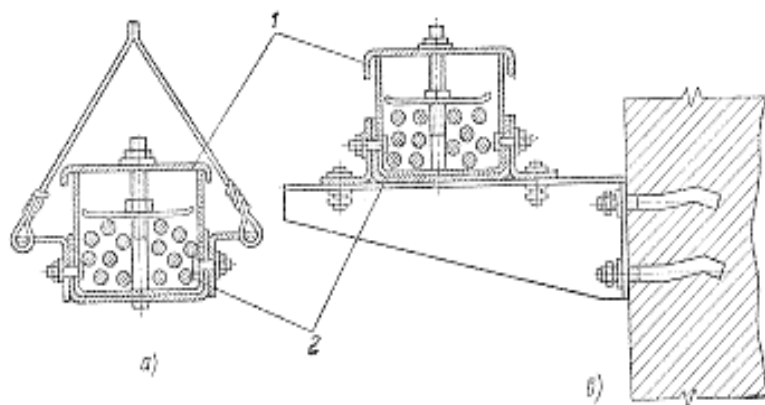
Выполнение открытой электропроводки в коробах:
